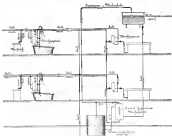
Schema einer Warmwasserheizung mit Wasserzählapparat
